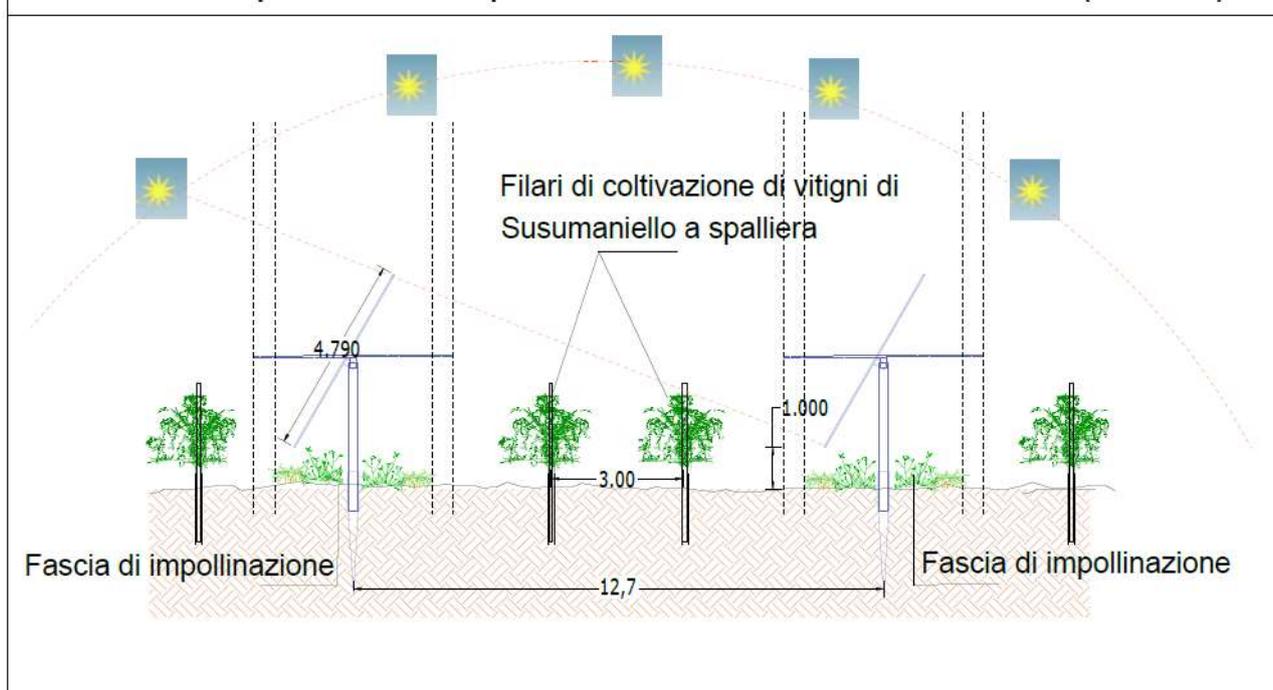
Particolare coltivazione vigneto interfila lotto 5B
